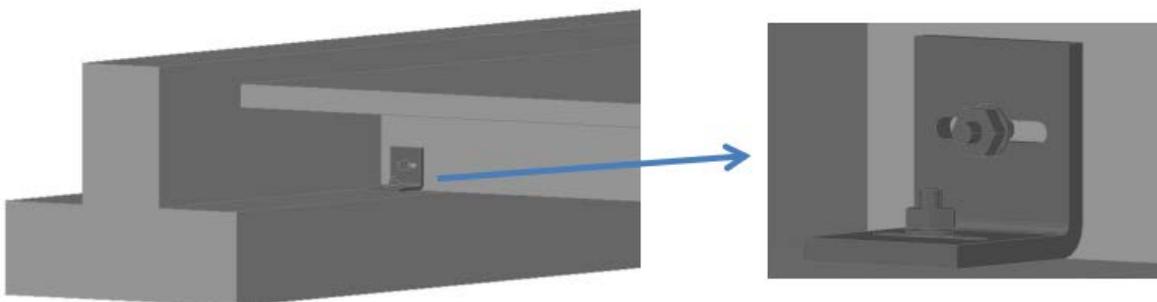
Rinforzo connessione tegolo-trave: aggiunta di meccanismi di dissipazione con squadrette deformabili
